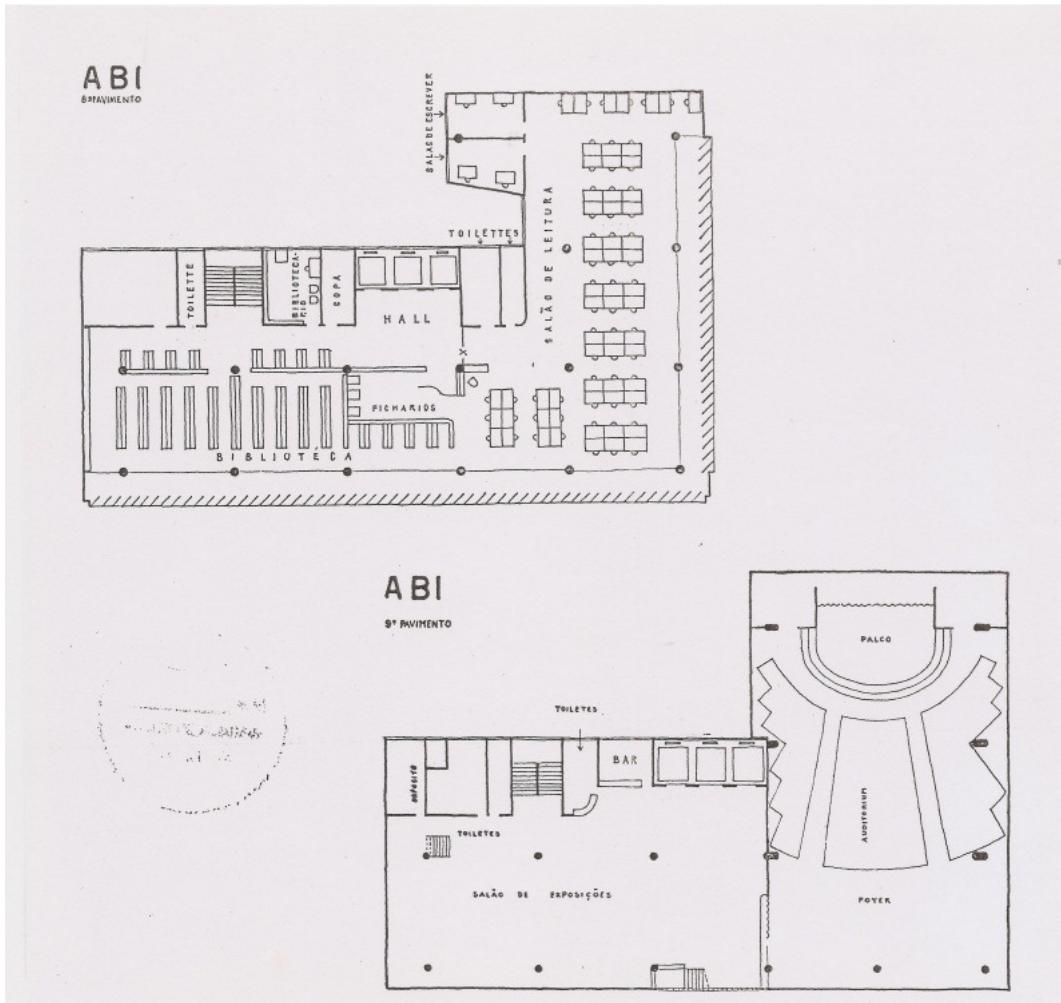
H – Plantas baixas do oitavo pavimento (biblioteca) e nono pavimento (auditório e sala de exposições)
